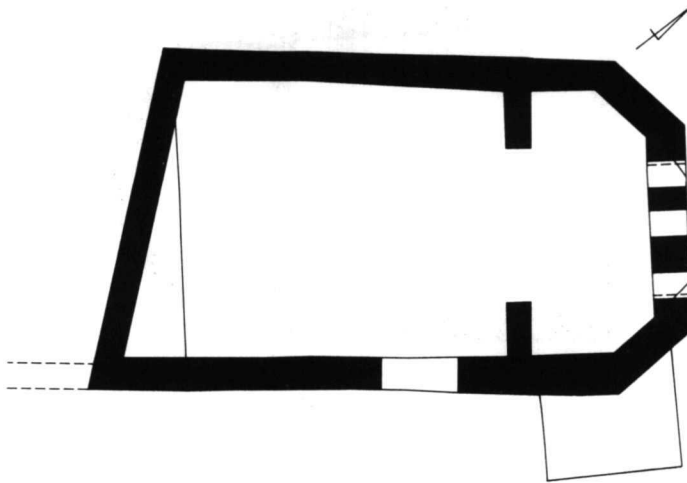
Fiesch, Kapelle Gnadenberg. Grundriss des Ursprungsbaus von 1343 mit den Umrisslinien des bestehenden Baus.
